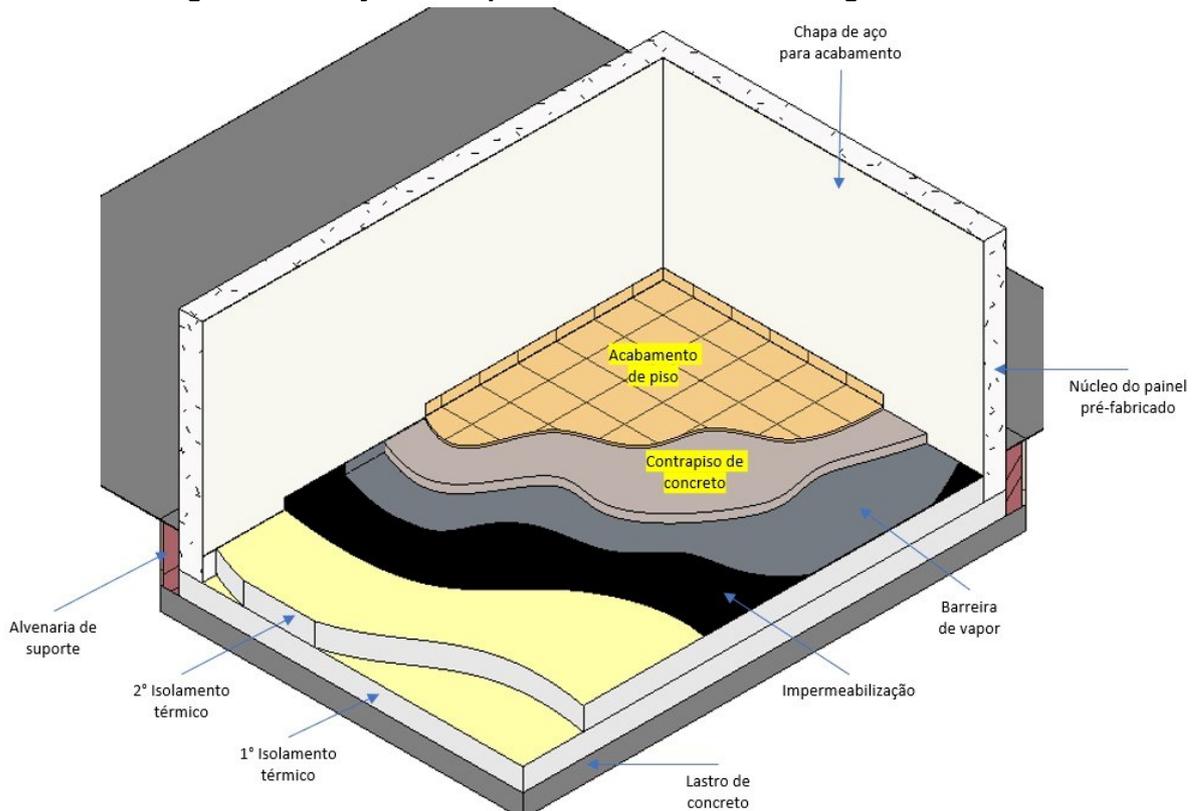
Instalação de infraestrutura em painéis pré-fabricados
